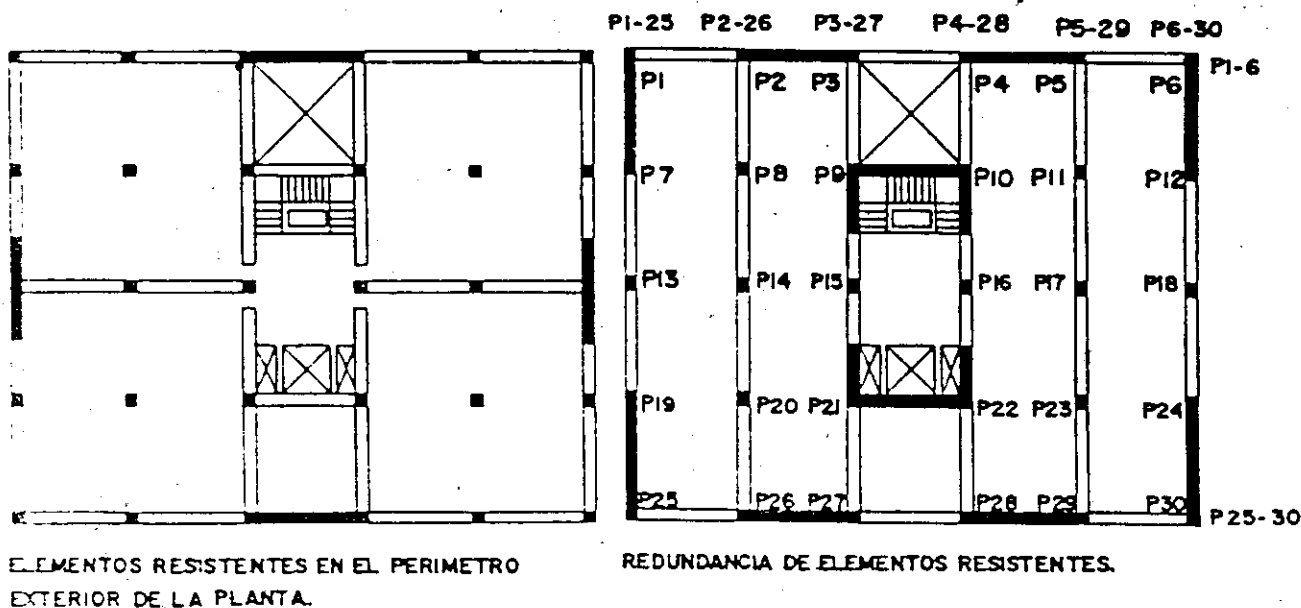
Disposiciones recomendadas de los elementos resistentes a las acciones horizontales
